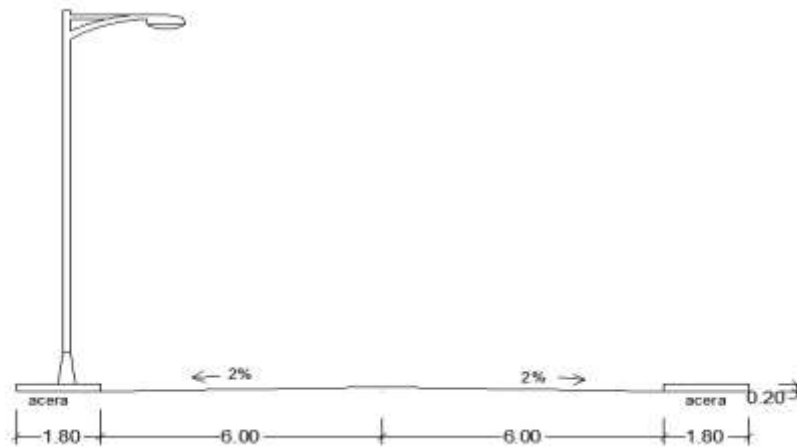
Sección transversal Tramo 1-2 Avenida Norte Sur 71
